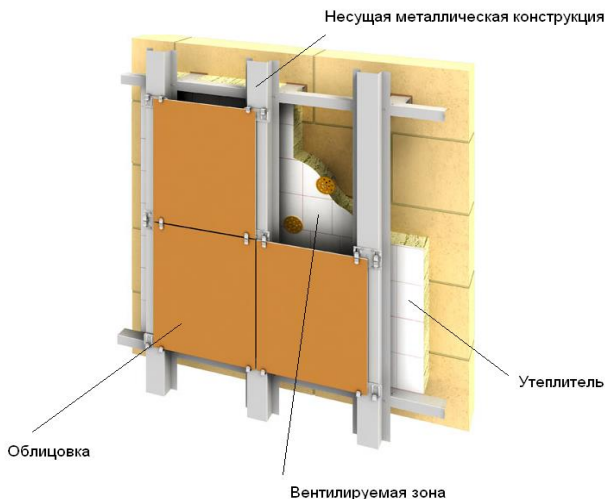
Навесной вентилируемый фасад облицовкой из керамогранита
